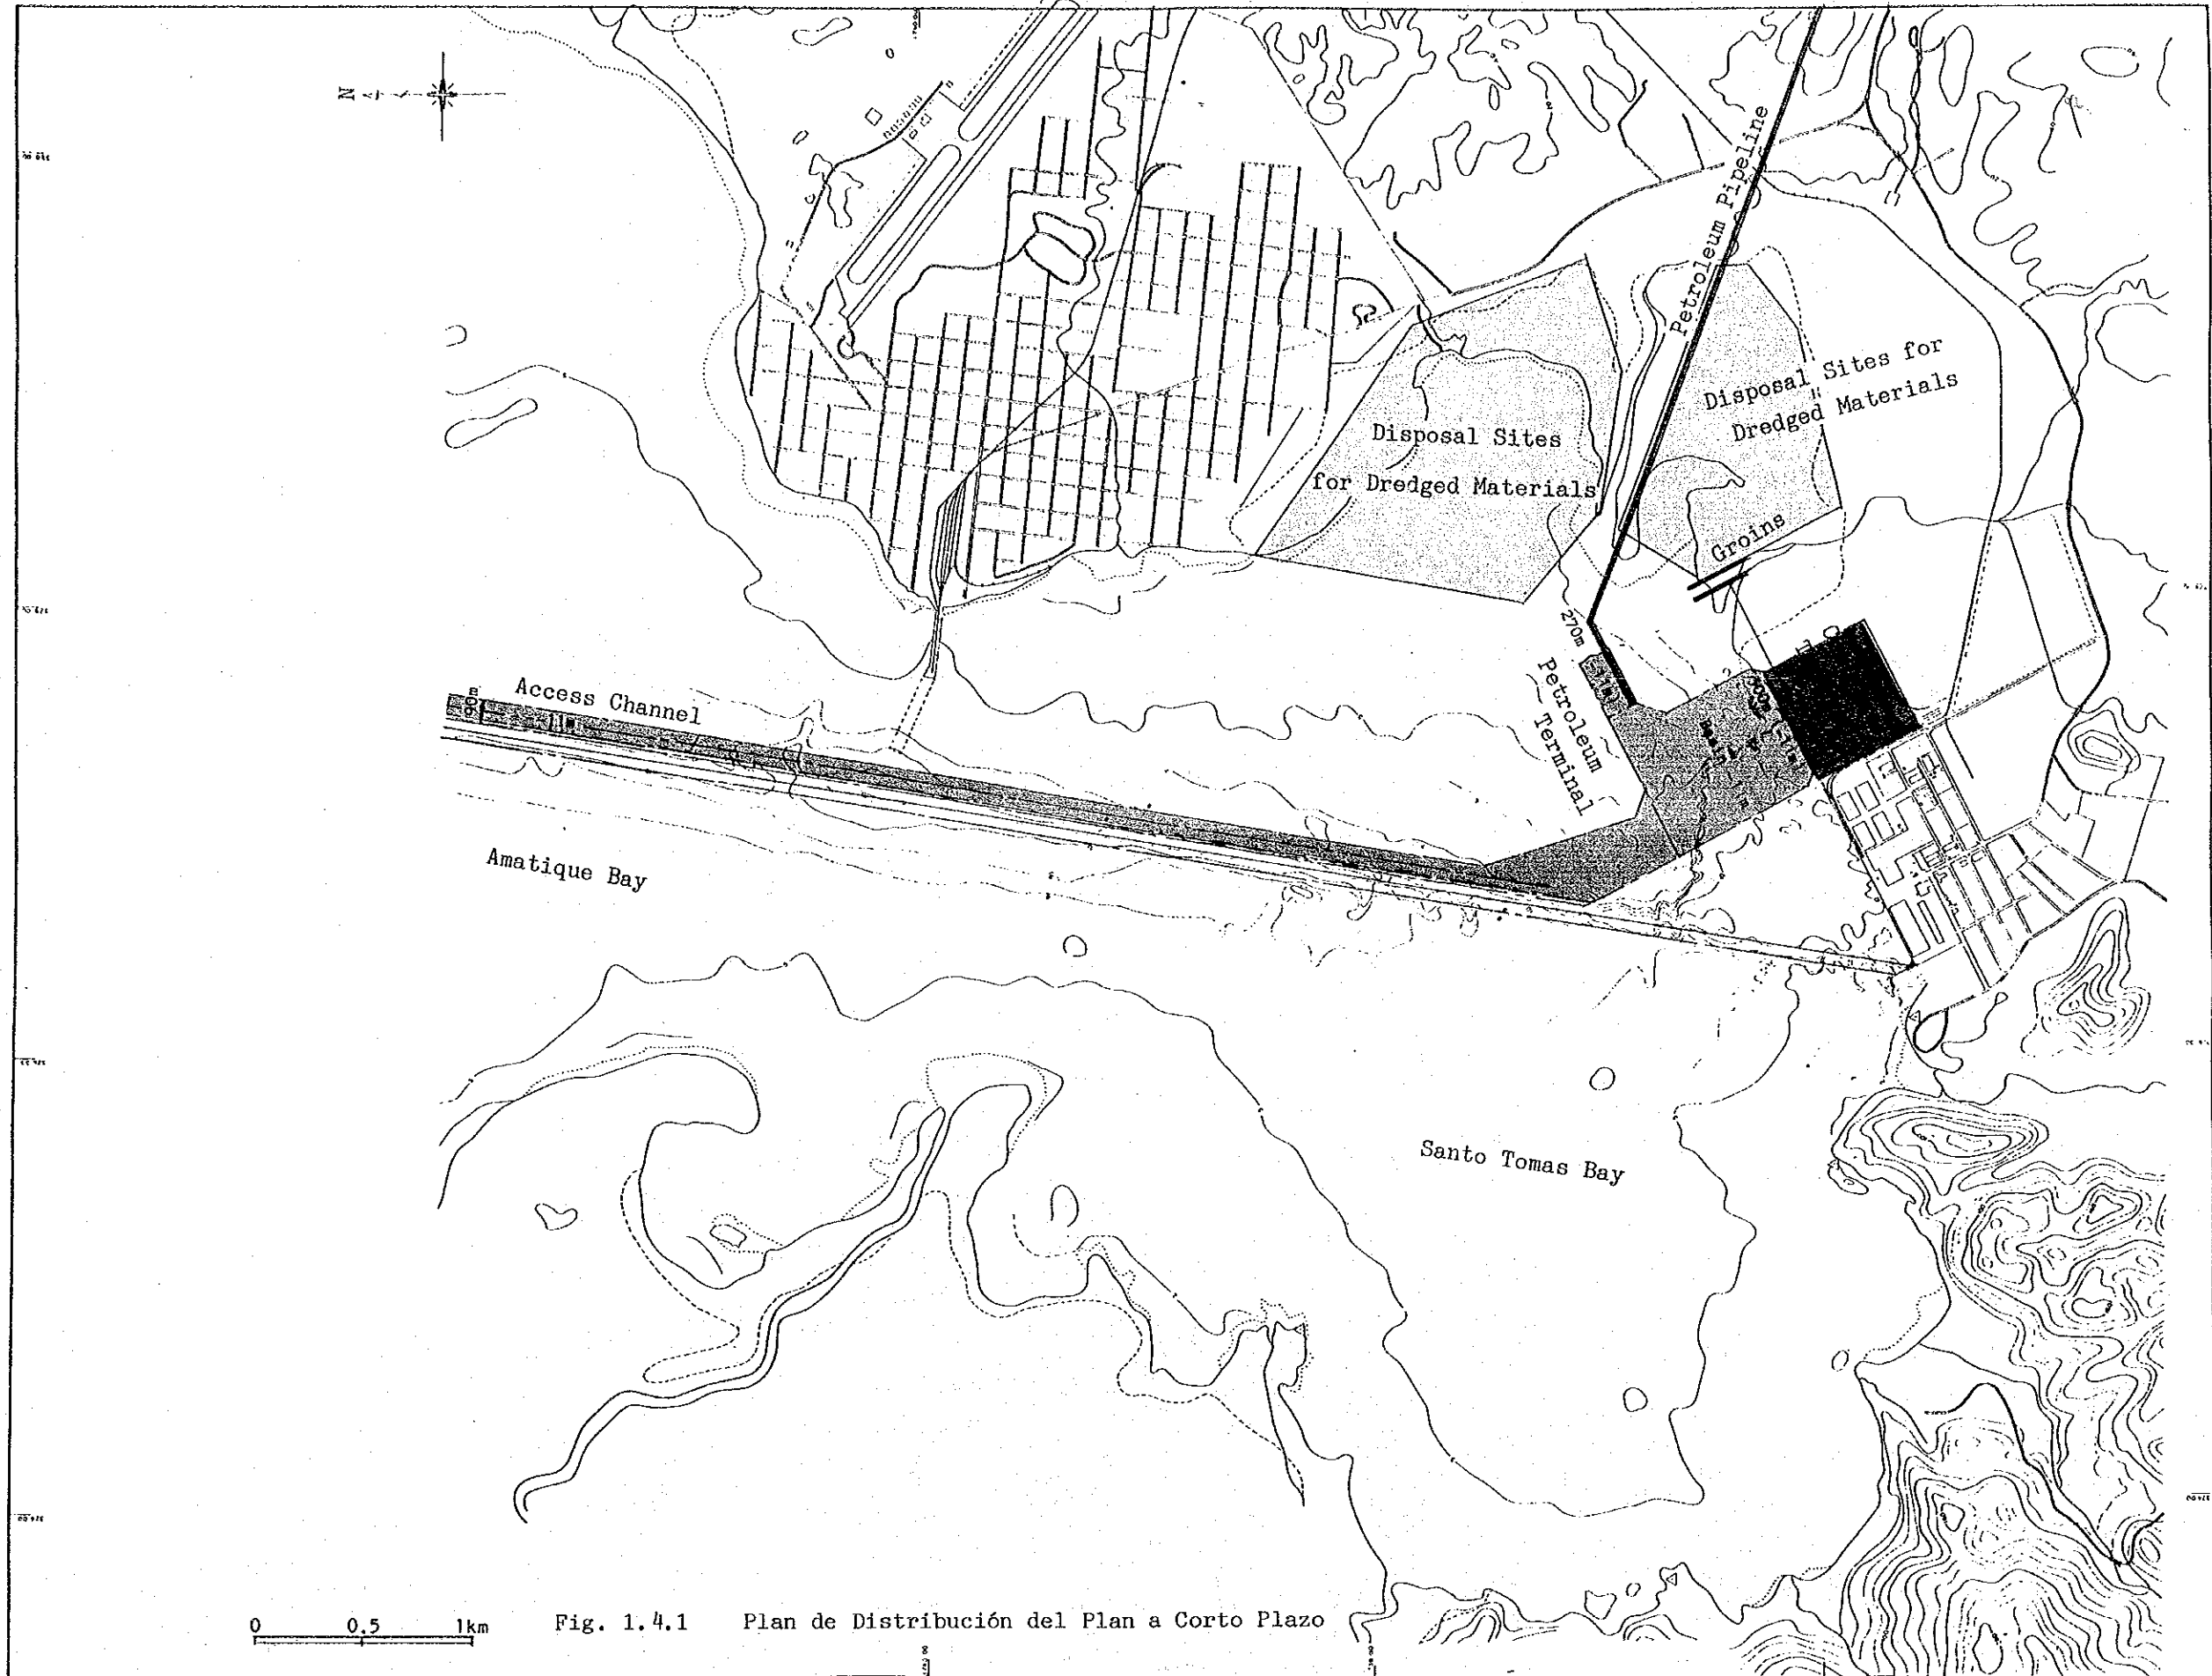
Plan de Distribución del Plan a Corto Plazo
